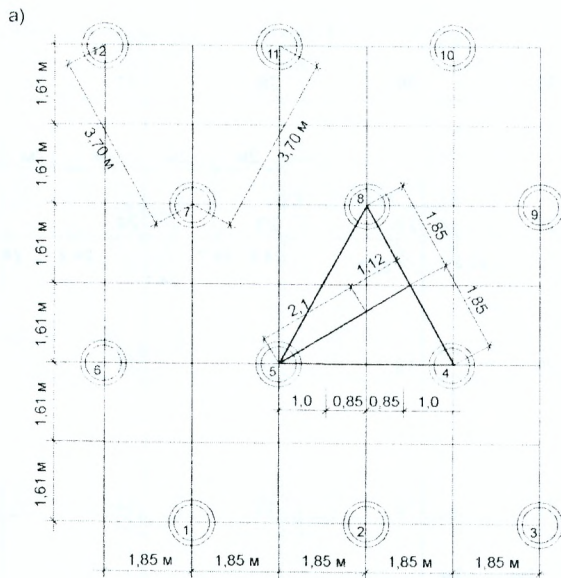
Треугольная схема отбора проб грунта, испытания штампами и зондированием опытной площадки
